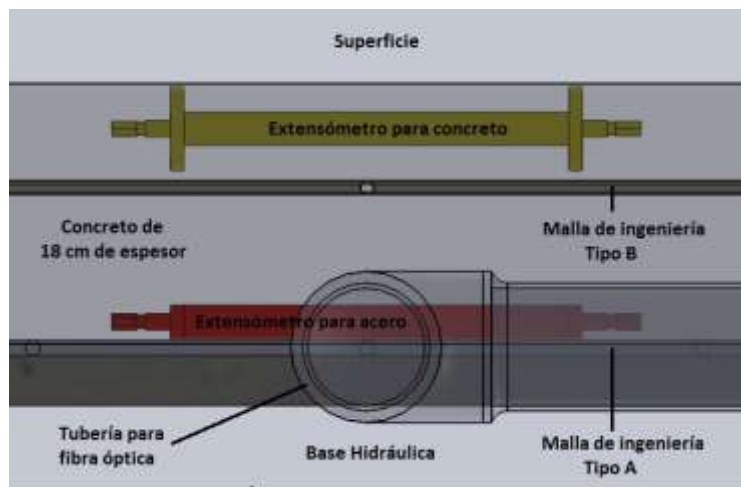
Distribución de extensómetros en la losa de concreto PCERC
